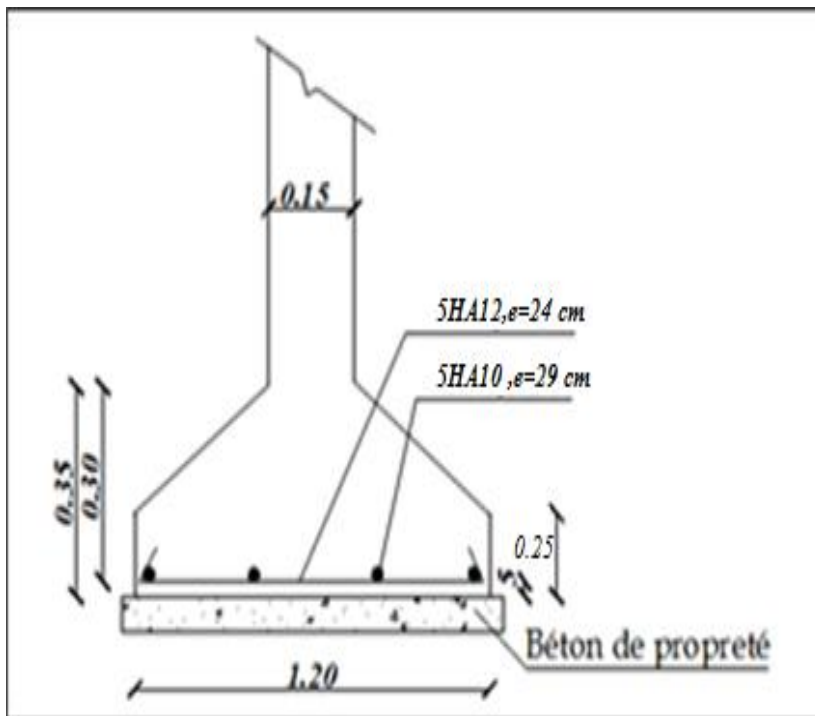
Exemple de ferrailage d'une semelle filante sous voiles.
